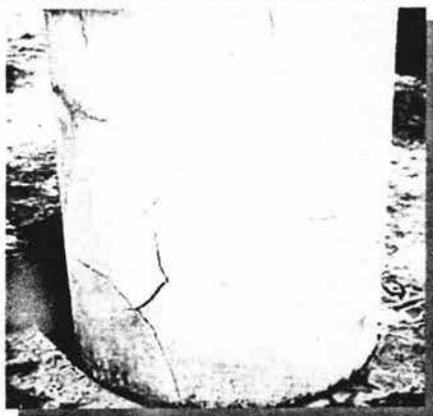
Presencia de grietas ocasionadas por la reacción álcali-agregado
